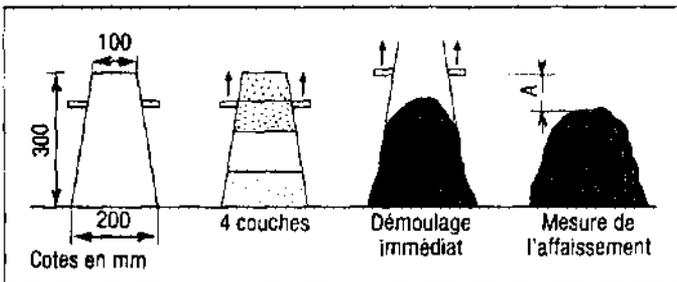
Essais d'ouvrabilité : cône d'Abrams (NF P 18-451).
